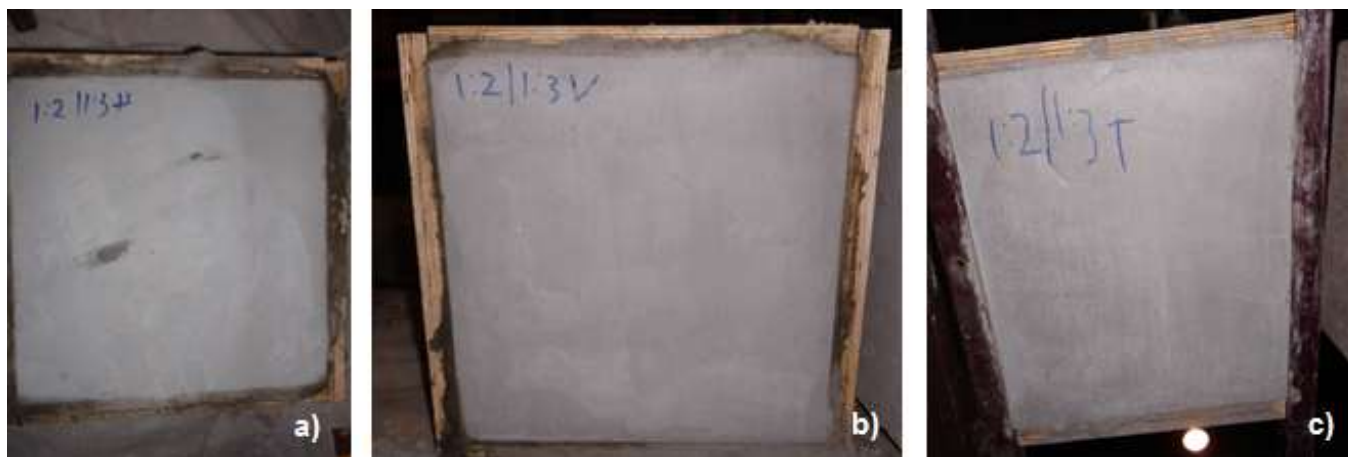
Argamassa PCM-SB-2 aplicada em lajetas representativas de pavimento (a), parede (b) e tecto (c).
